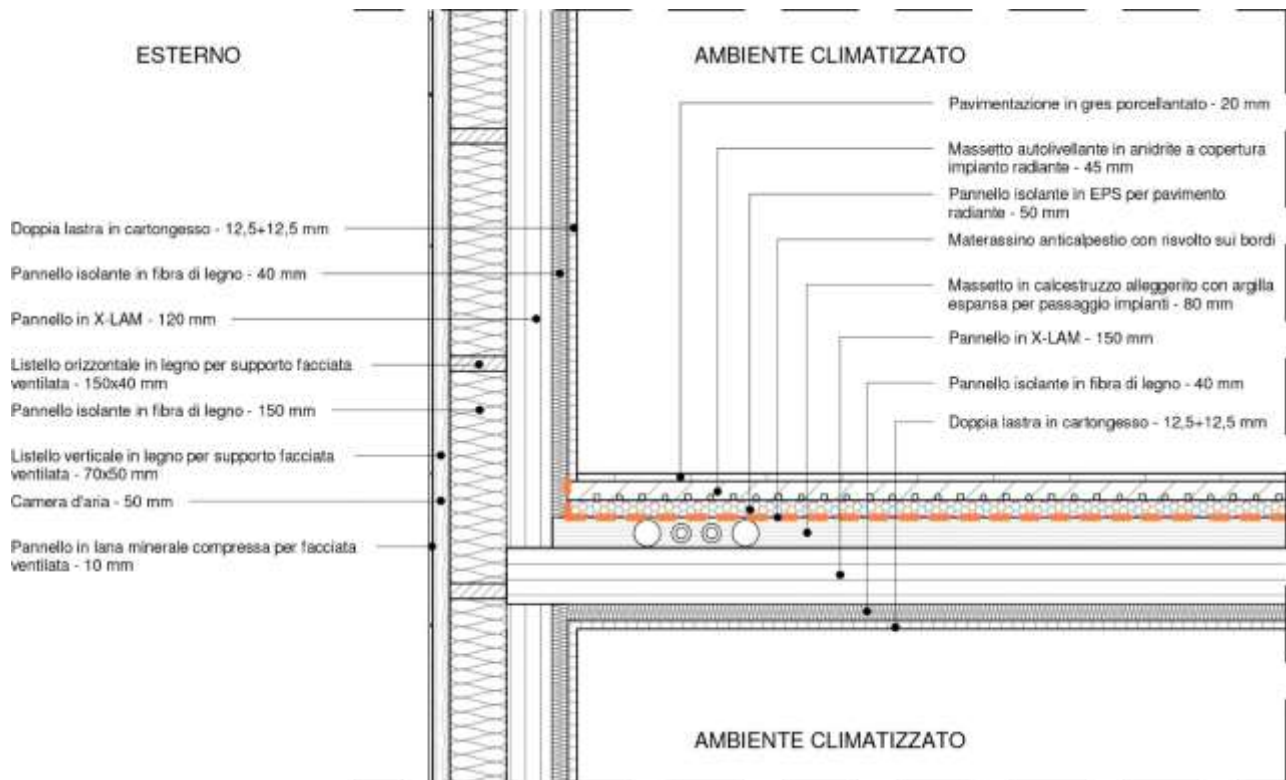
Dettaglio costruttivo nodo parete ventilata esterna e solaio intermedio - scala 1:20. [Fonte: elaborazione dell'autore]
